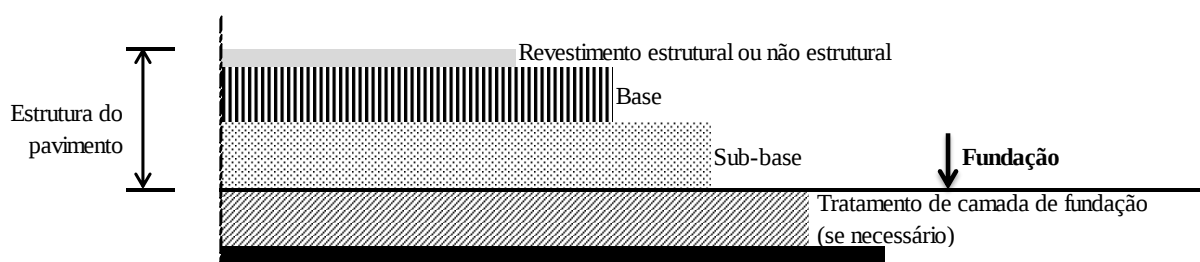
Estrutura esquemática de um pavimento rodoviário (adaptado de ERA, 2011)
